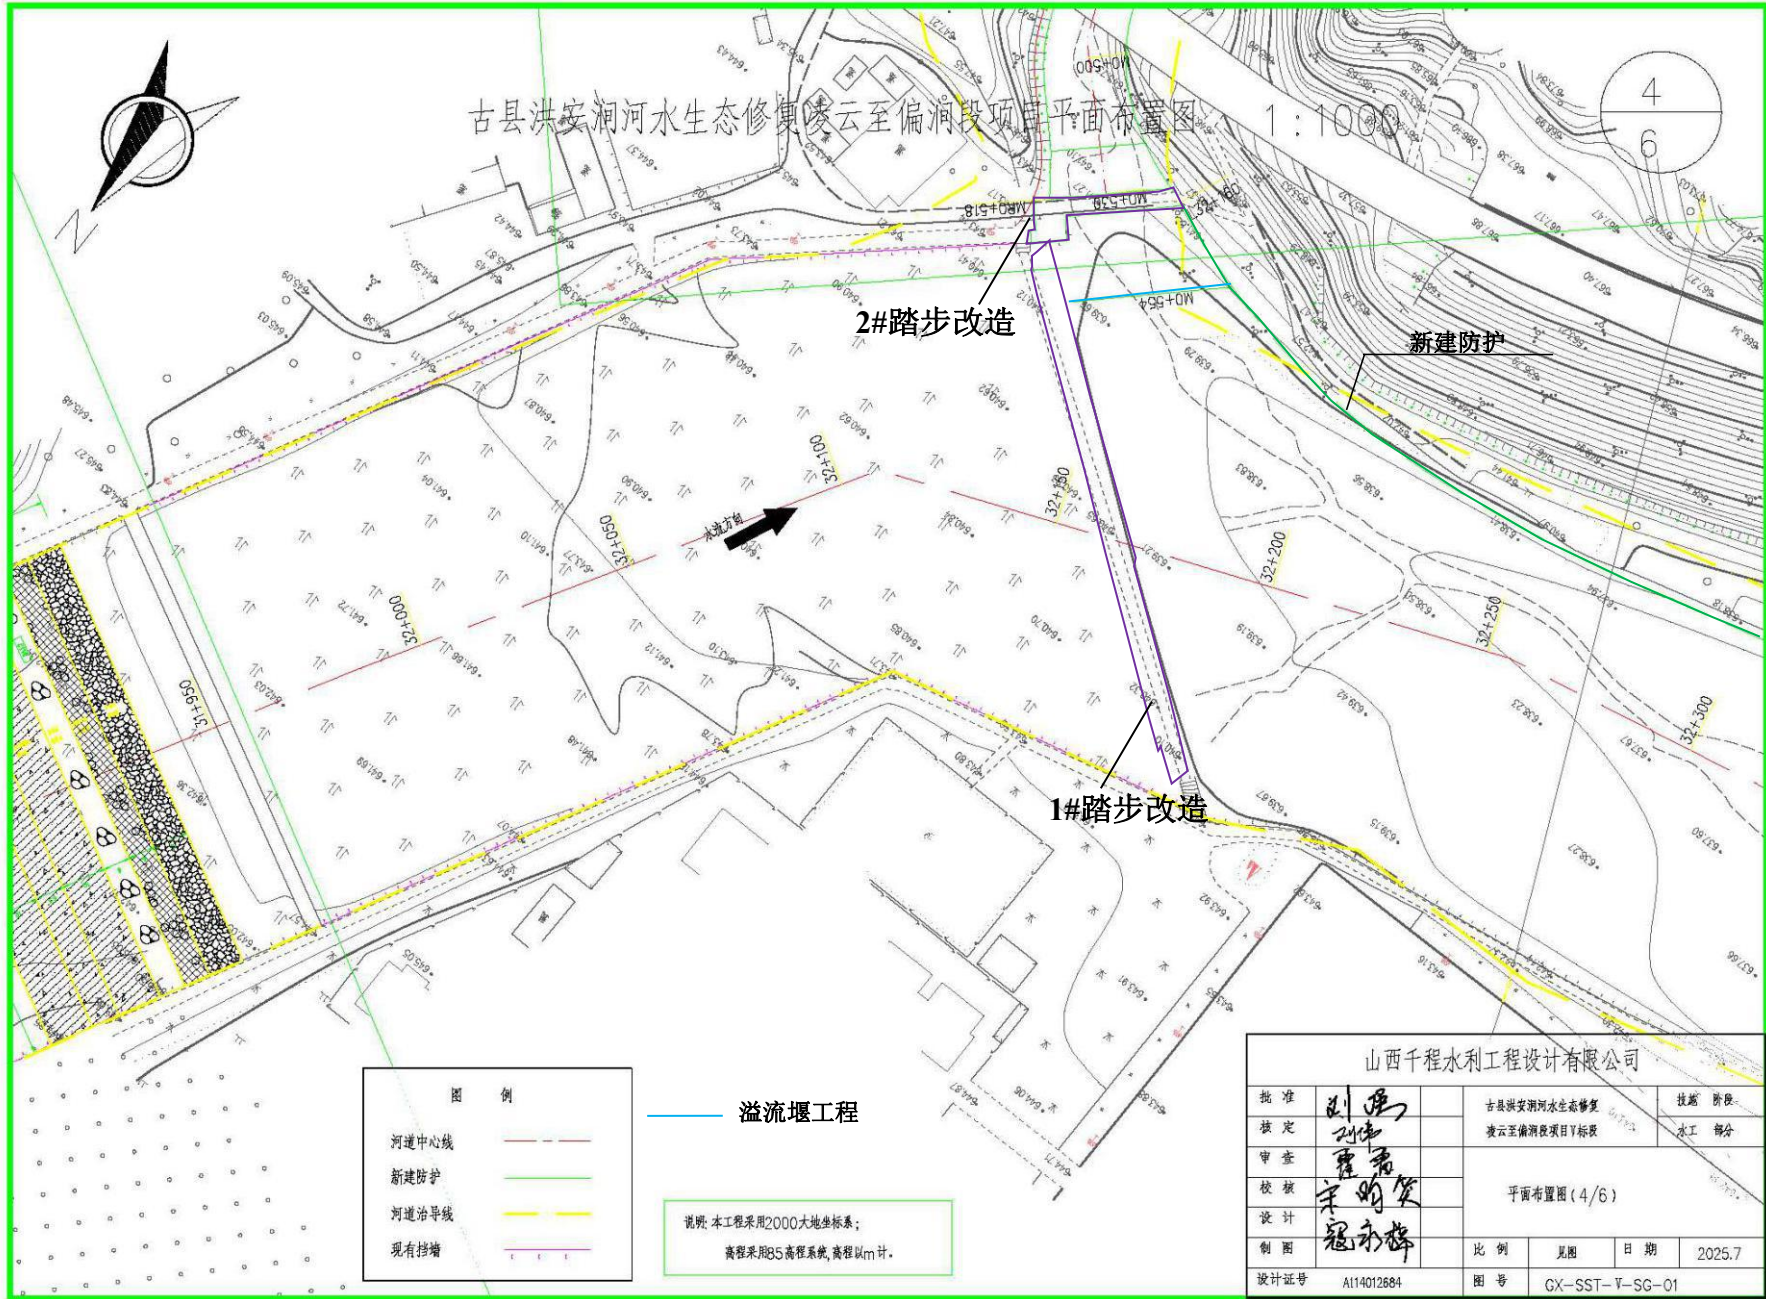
(17) 工程总平面布置图 (桩号 31+600-32+300)
